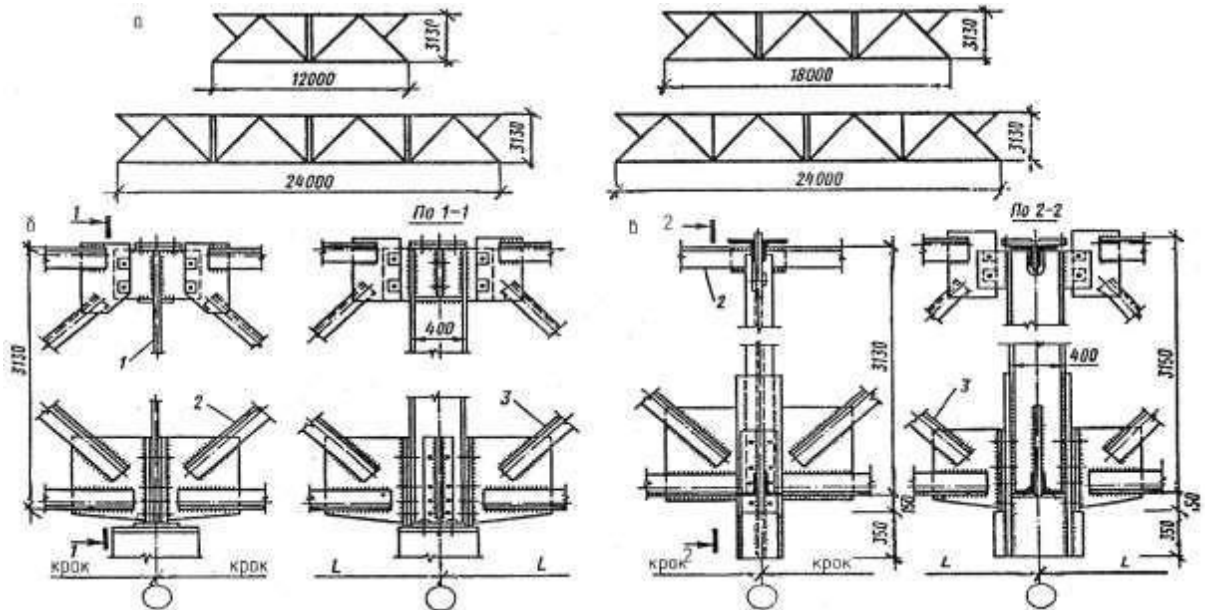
Сталеві підкроквяні ферми: а – схеми підкроквяних ферм; б – вузол спирання підкроквяної ферми на колону; в – спирання кроквяної ферми на під кроквяну; 1 – стінка надопорної стійки; 2 – підкроквяна ферма; 3 – кроквяна ферма.
